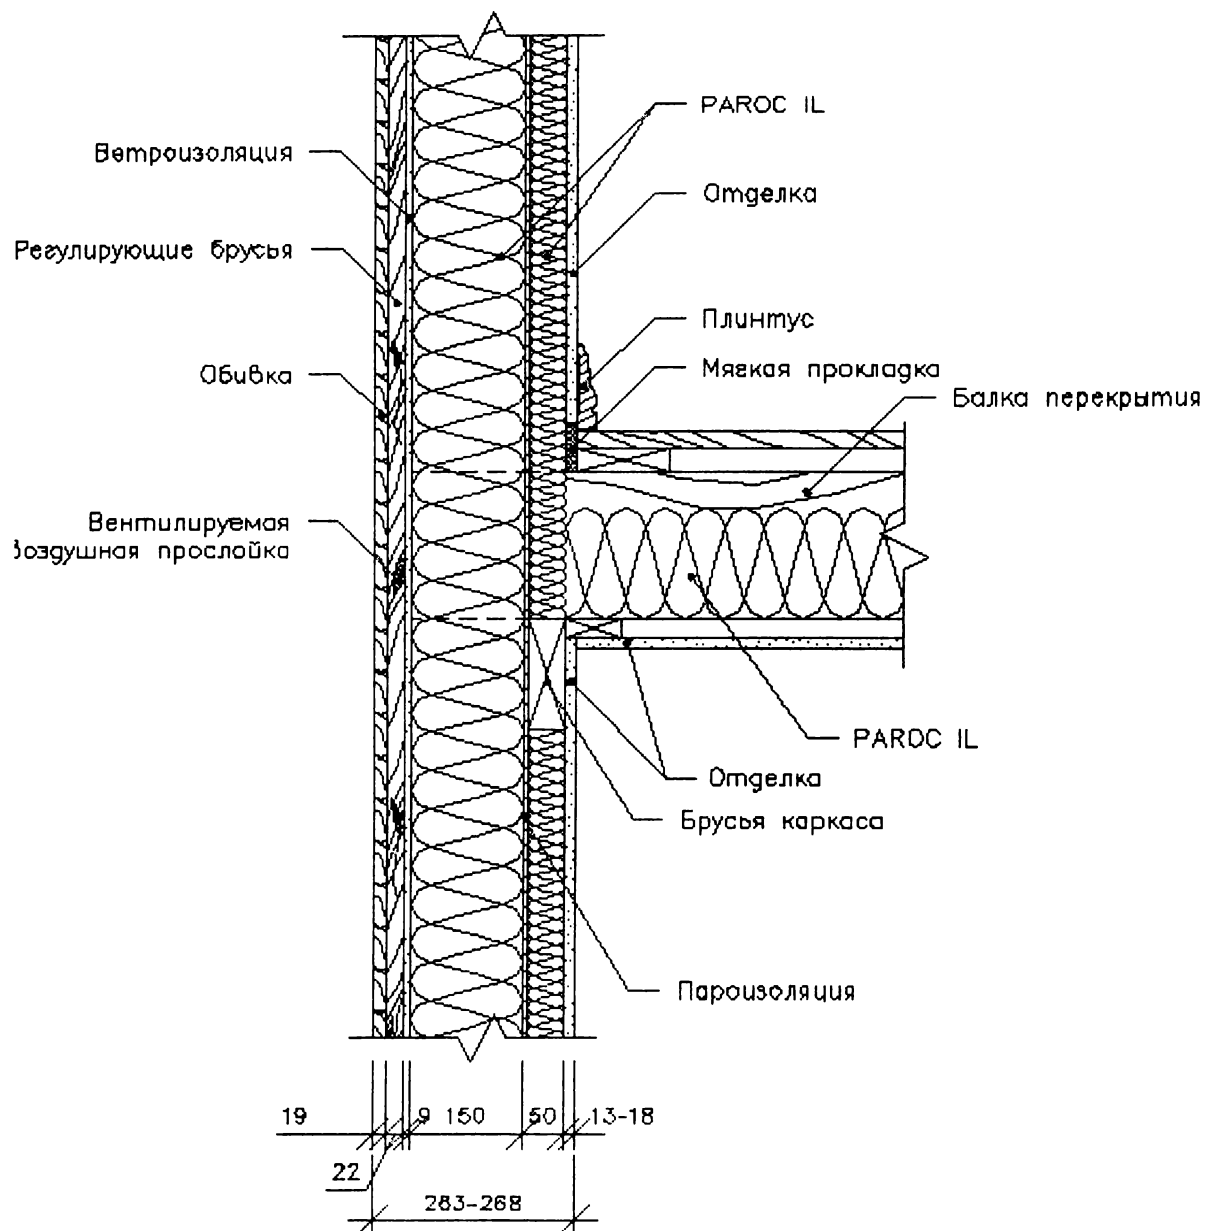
Деталь утепления деревянной каркасной стены с деревянным каркасным перекрытием
